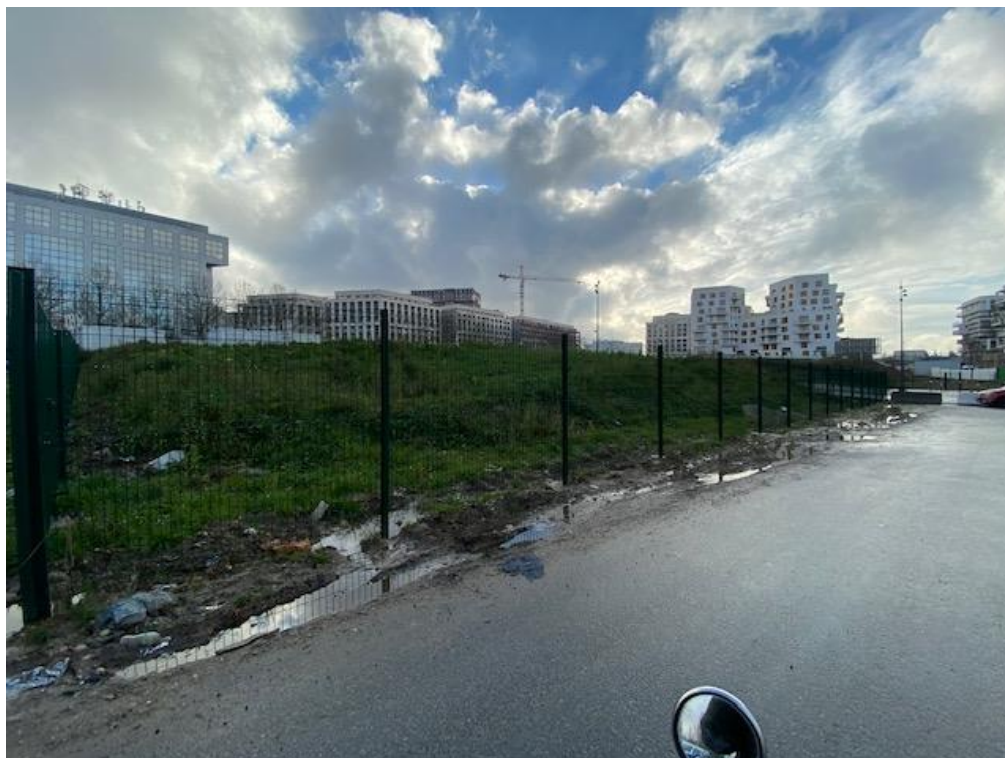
Zone de stationnement en enrobé sur le site 2/2
